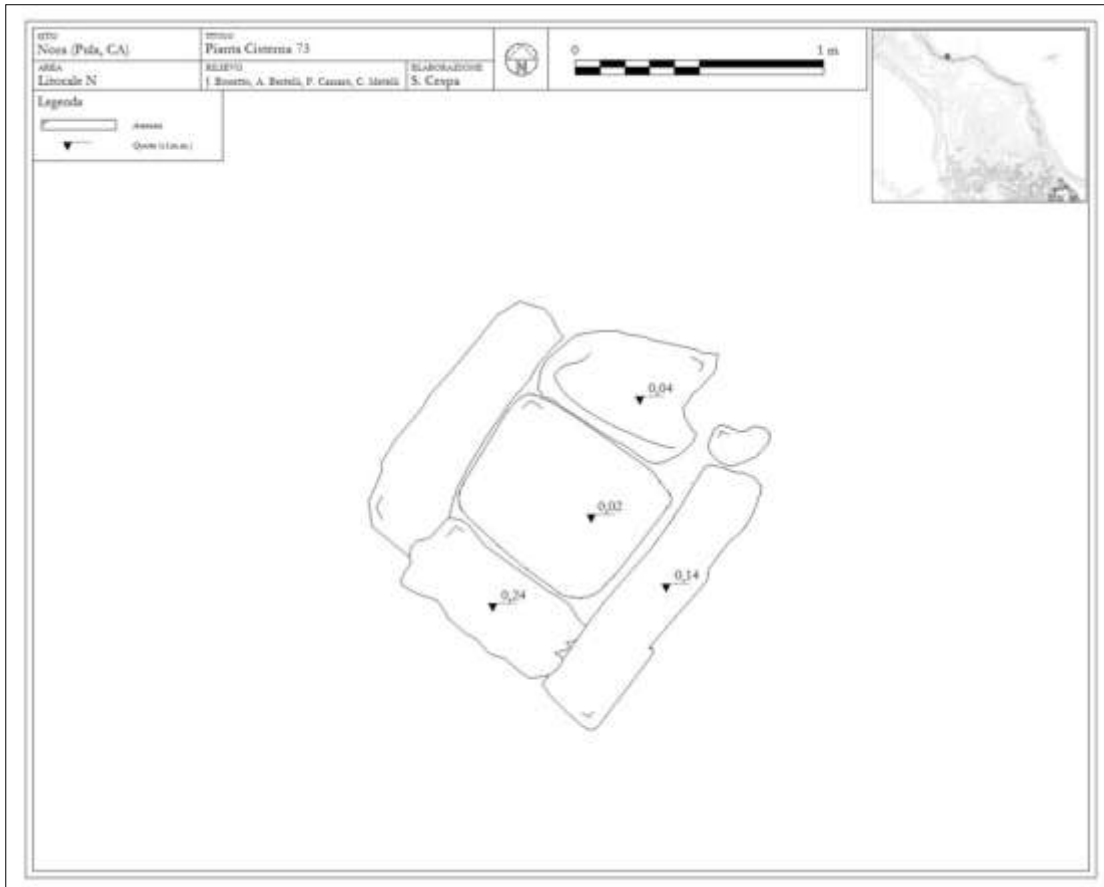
Pianta del pozzo/cisterna 73 (elaborazione dell'autore).
